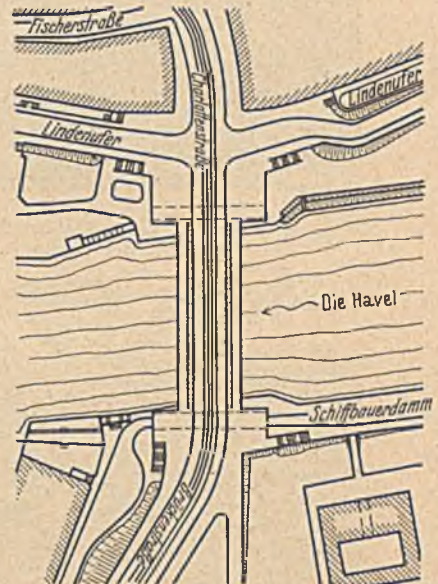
Charlottenbrücke über die Havel in Berlin-Spandau — neue Brückenlage — Lageplan.
